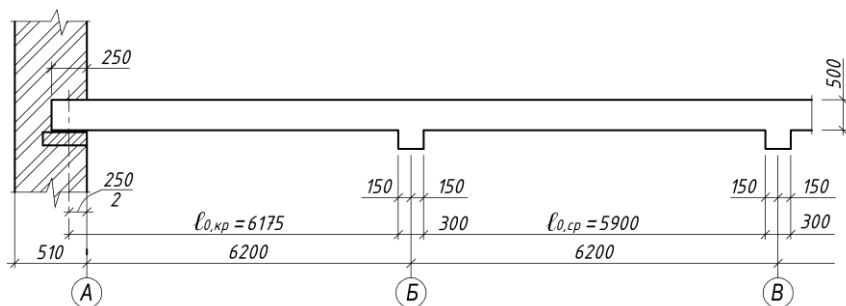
Схема расчетных пролетов второстепенной балки
